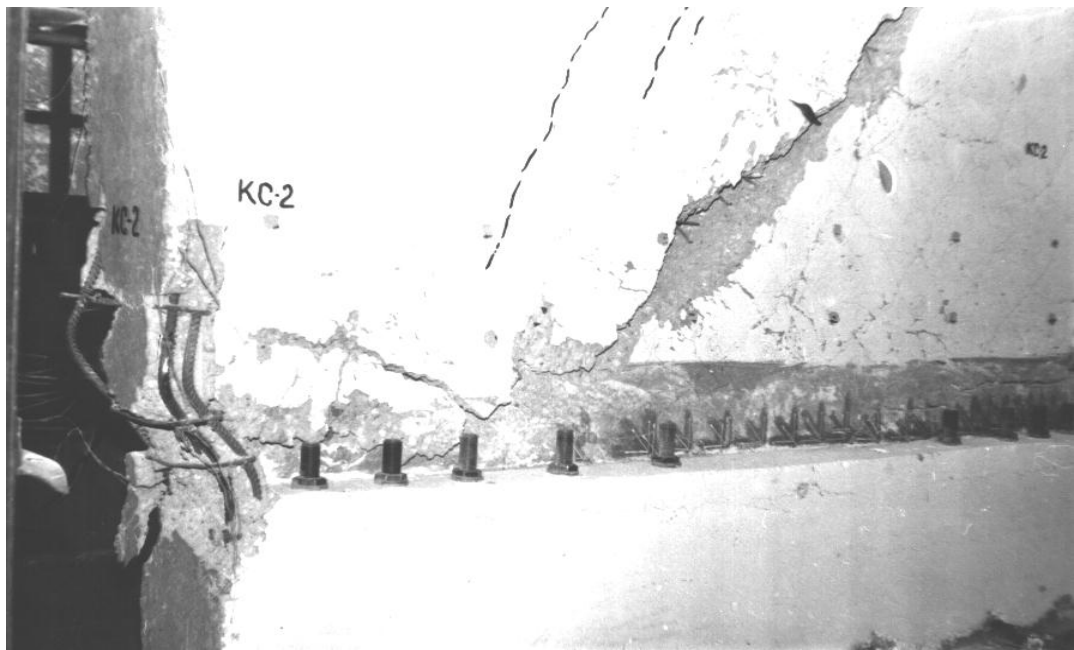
Выпучивание контурной арматуры и разрушение сжатой зоны бетона в панелях при испытаниях многократно повторяющейся горизонтальной нагрузкой.
